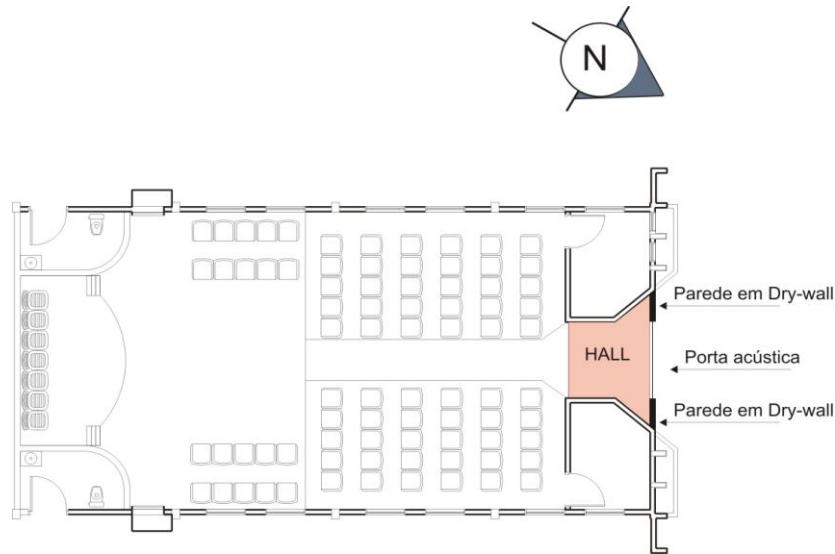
Planta baixa, com destaque para o Hall de entrada.
